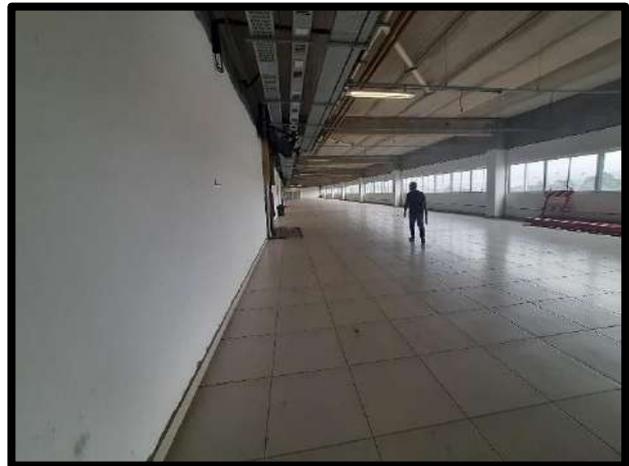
CIRCULAÇÃO 5º PAVIMENTO
